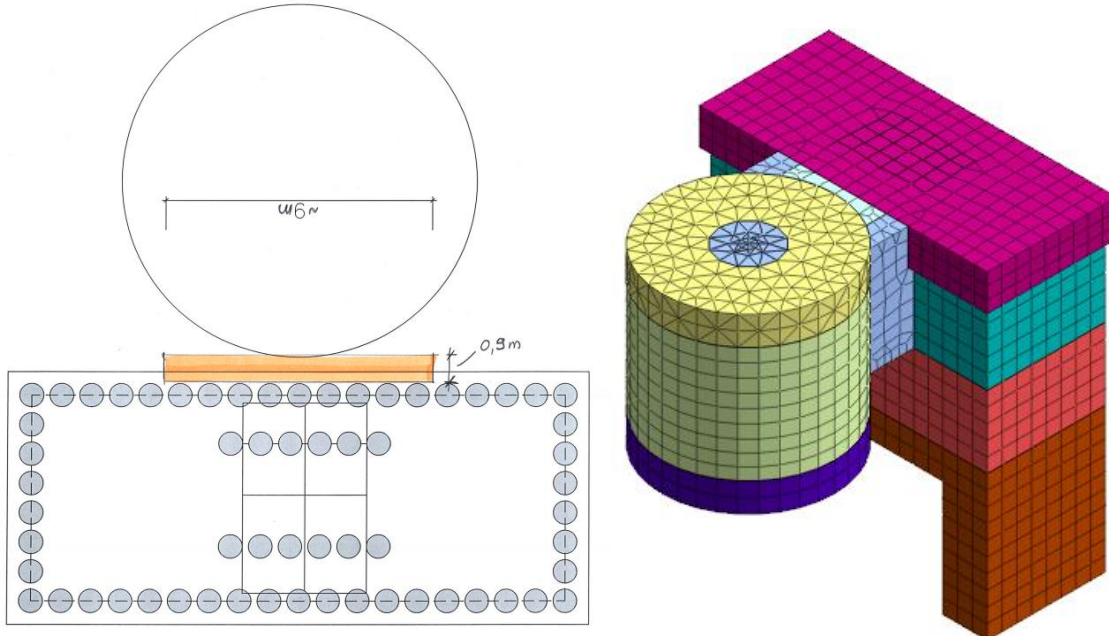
Dettaglio e modellazione dell'interfaccia molle tra le due fondazioni
